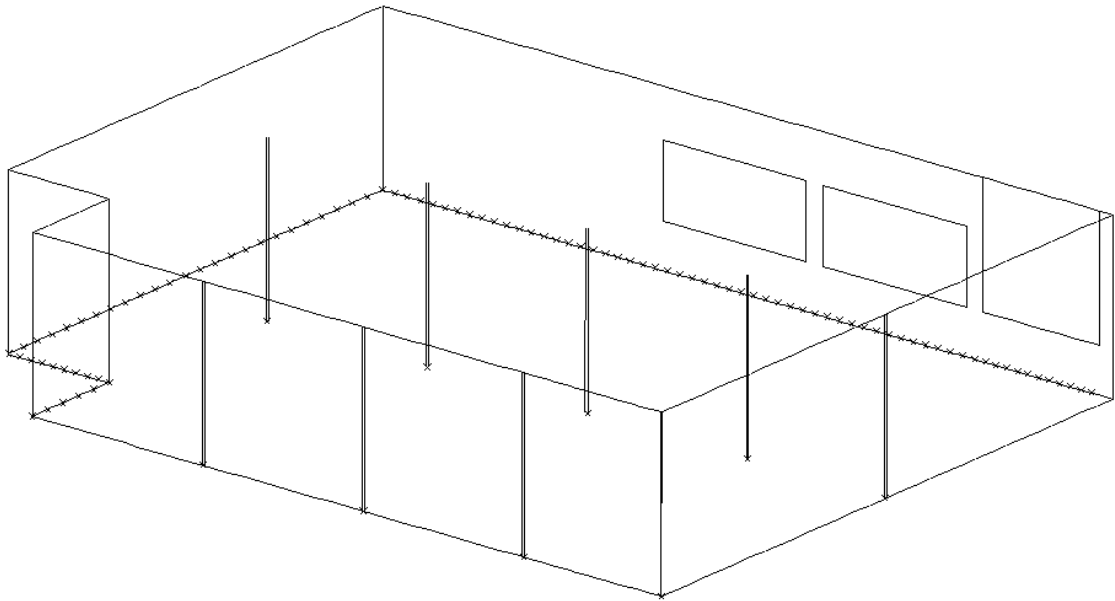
Statisches System des eingeschossigen Anbaus, BV Schlosserei, Holzgerlingen
